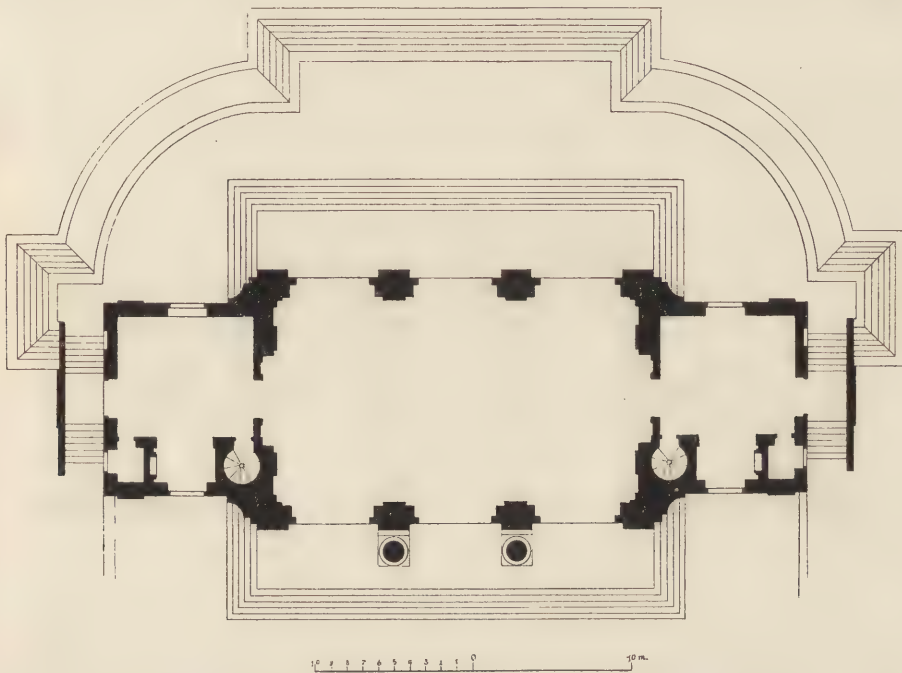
Sächsisches Palais zu Warfchau. Ehemaliger Gartenfaal, Grundriss.
